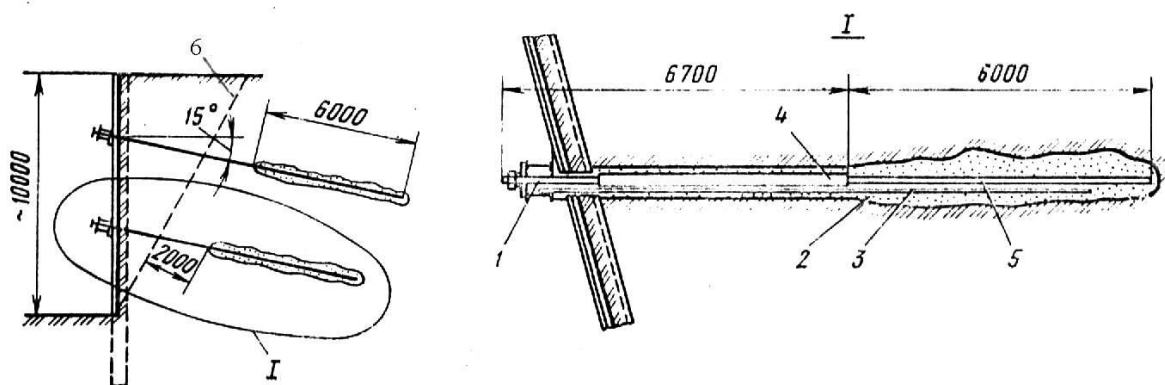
Анкерное крепление котлована и конструкция анкера:
